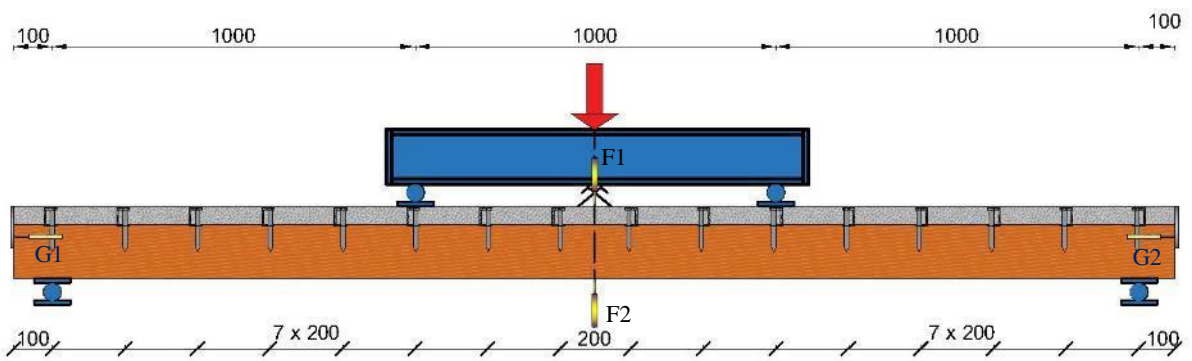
Configuration 1 – poutre avec connecteurs en U (PT-HA12UA)
